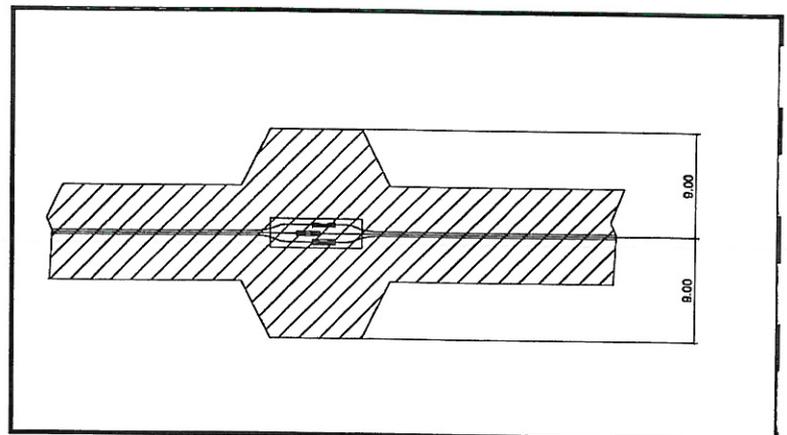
Rappresentazione planimetrica della fascia di rispetto (DpA)
